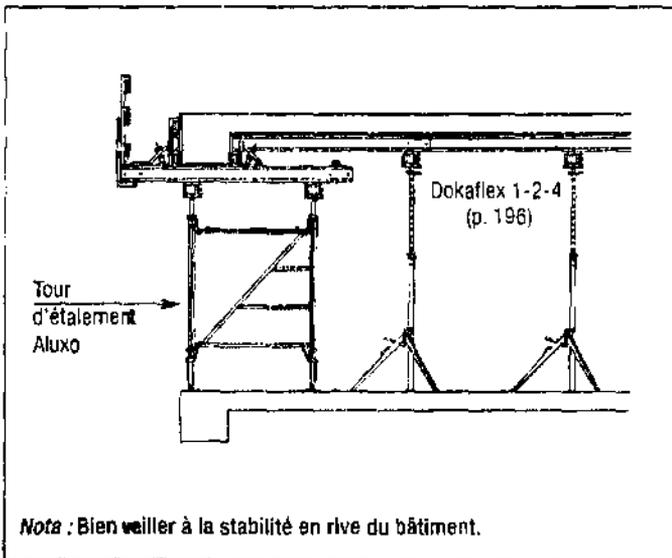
Exemple de coffrage d'arrêt de dalle avec retombée de poutre sous dalle.
